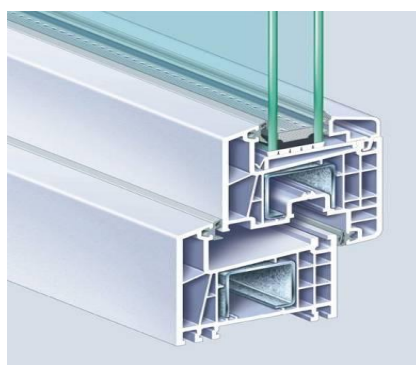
ПВХ профиль однокамерного стеклопакета со стальными вкладышами
